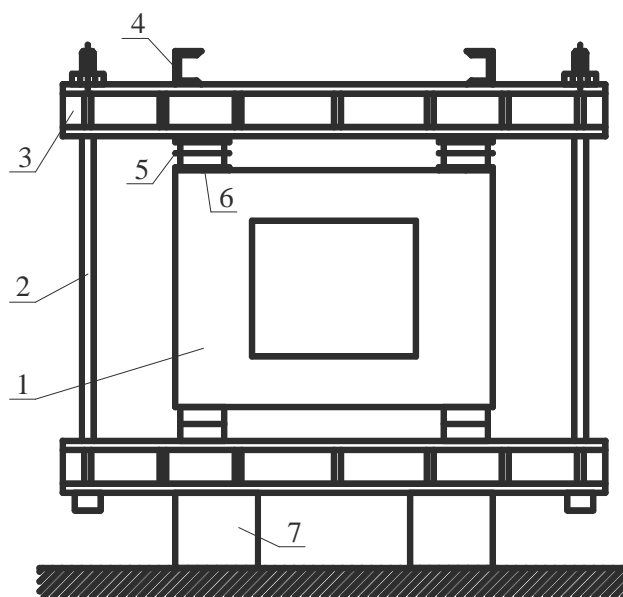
Схема испытания объемного блока: 1 – объемный блок; 2 – тяжи; 3 – опорные балки; 4 – раскрепляющие балки; 5 – гидравлические домкраты; 6 – прокладки; 7 – переставные бетонные опоры
